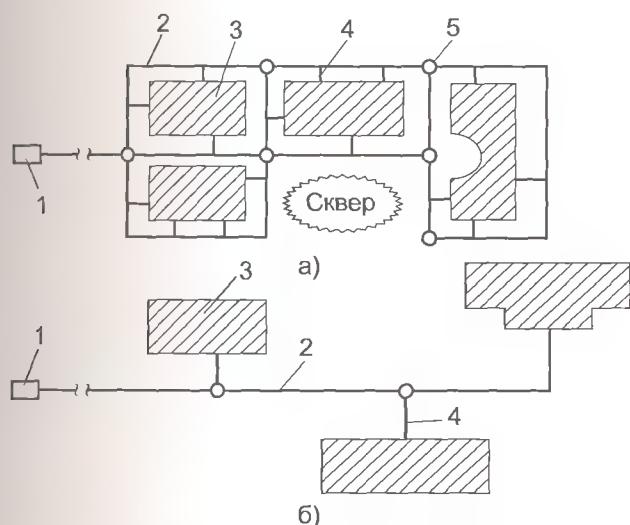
Принципиальные схемы наружных водопроводных сетей:
